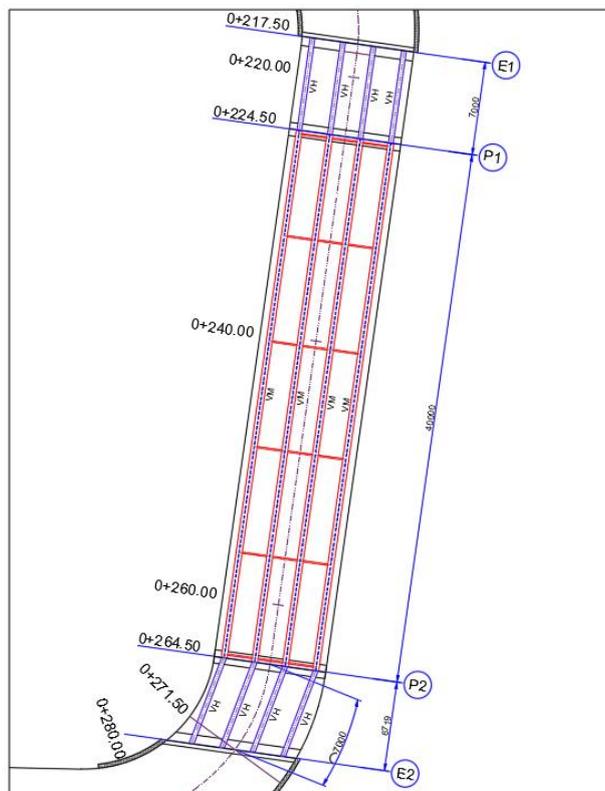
Vista en planta de la estructura del puente [Elaboración propia]
